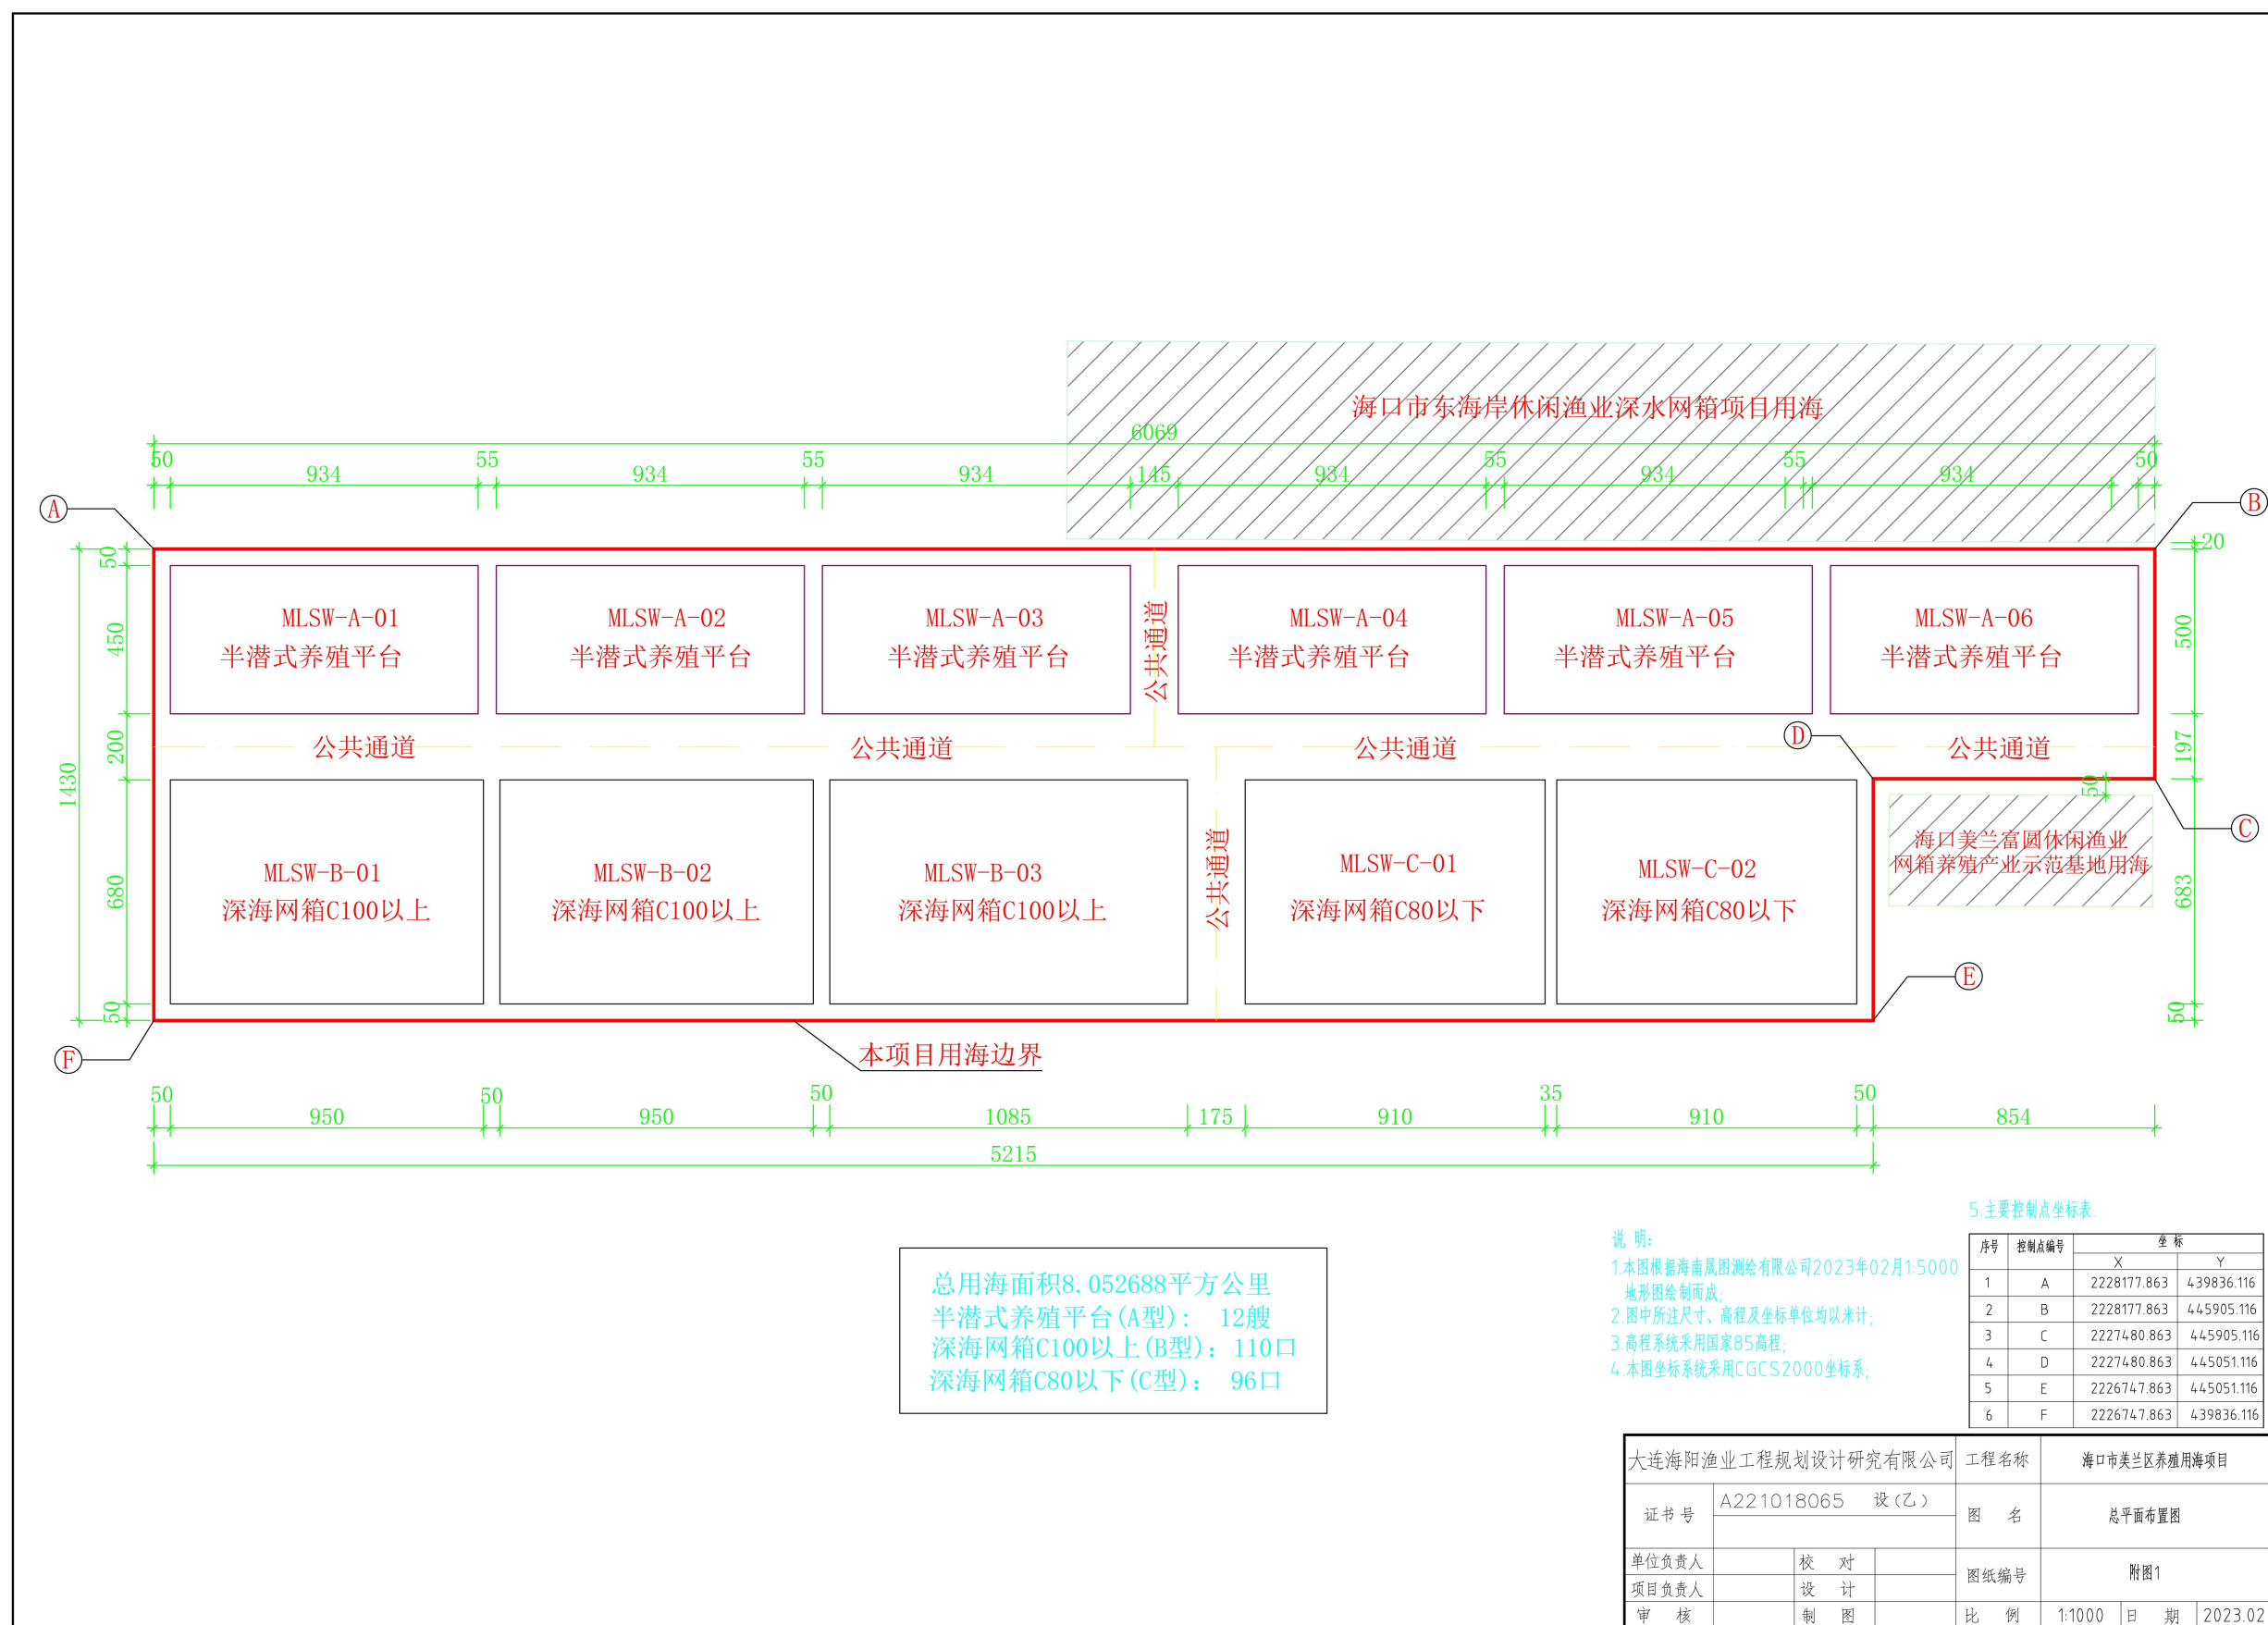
海口市美兰区养殖用海项目整体总平面布置图
